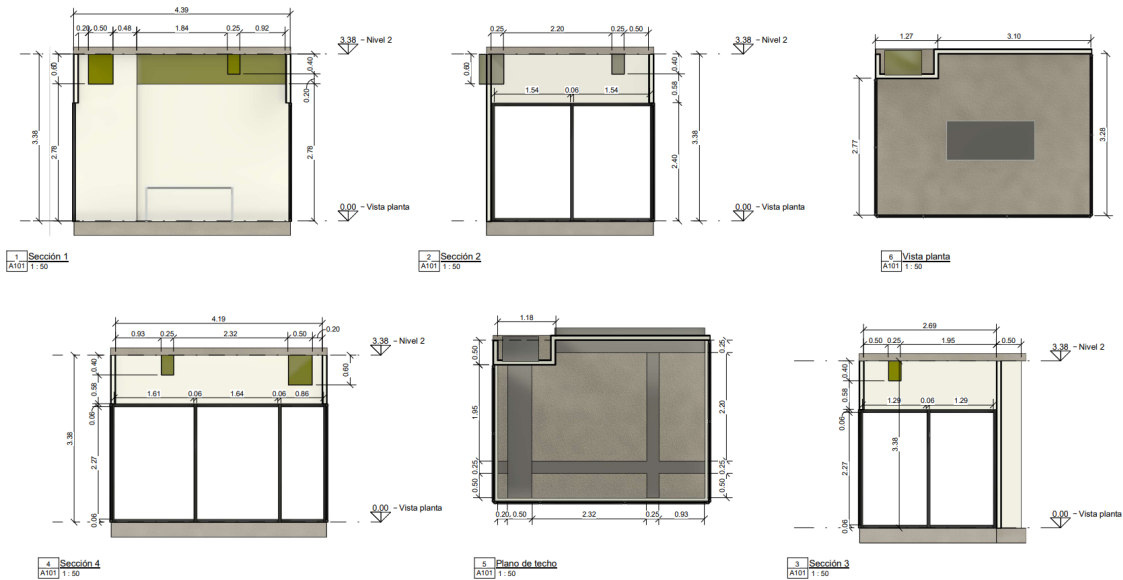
Secciones, vista en planta y de techo reflejado de CIT 421
